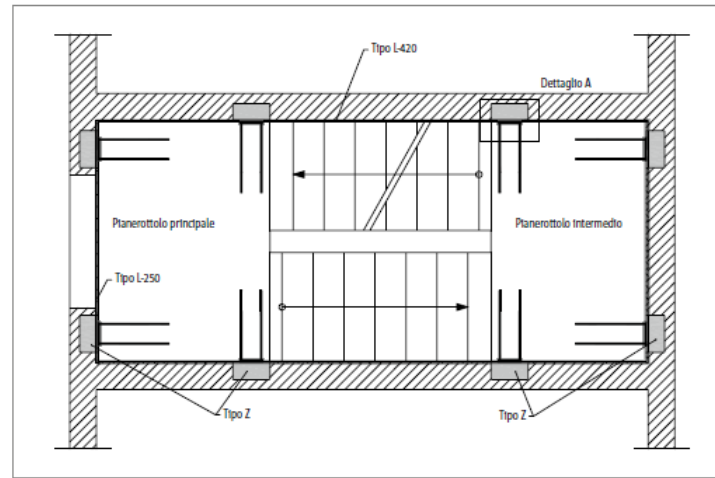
Schöck Tronsole® tipo Z, disposizione alternativa dell'elemento nella pianta
